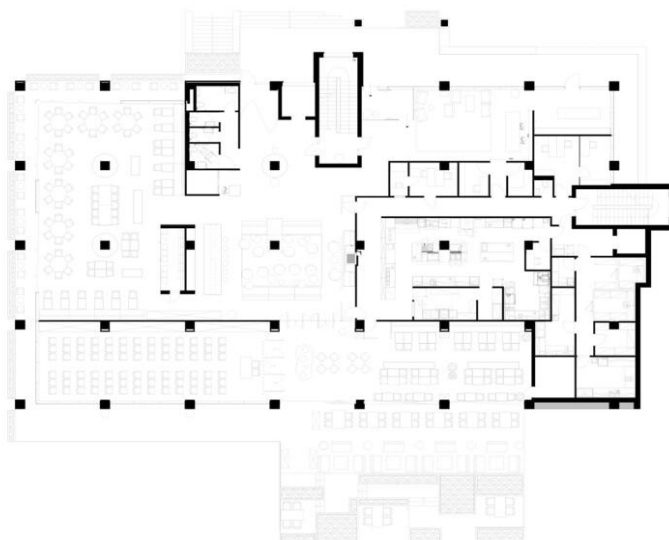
План першого поверху Бутік-готелю [11]
